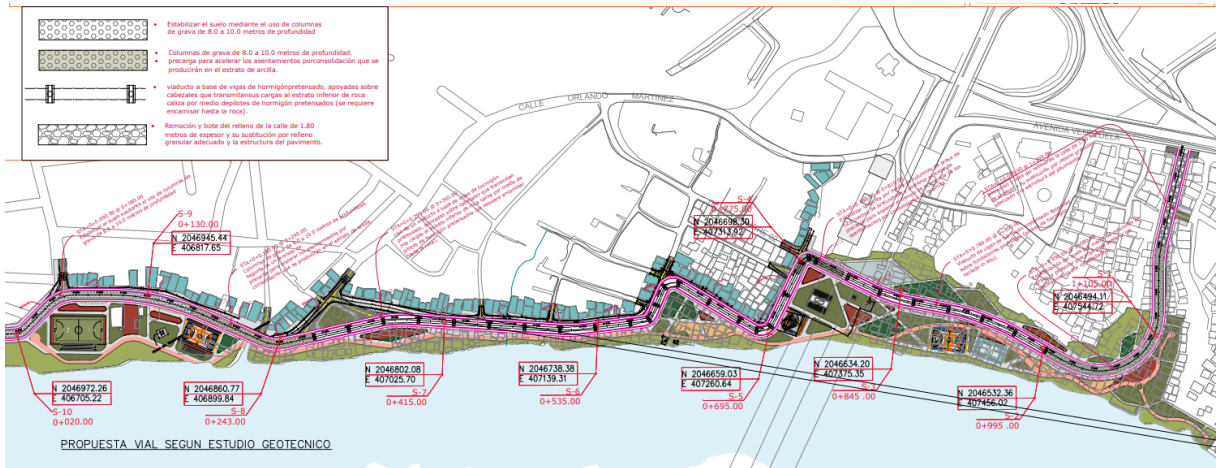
Propuesta de estabilización del suelo para el barrio de las Lilas (Etapas 1-3). Fuente: URBE, octubre 2025
